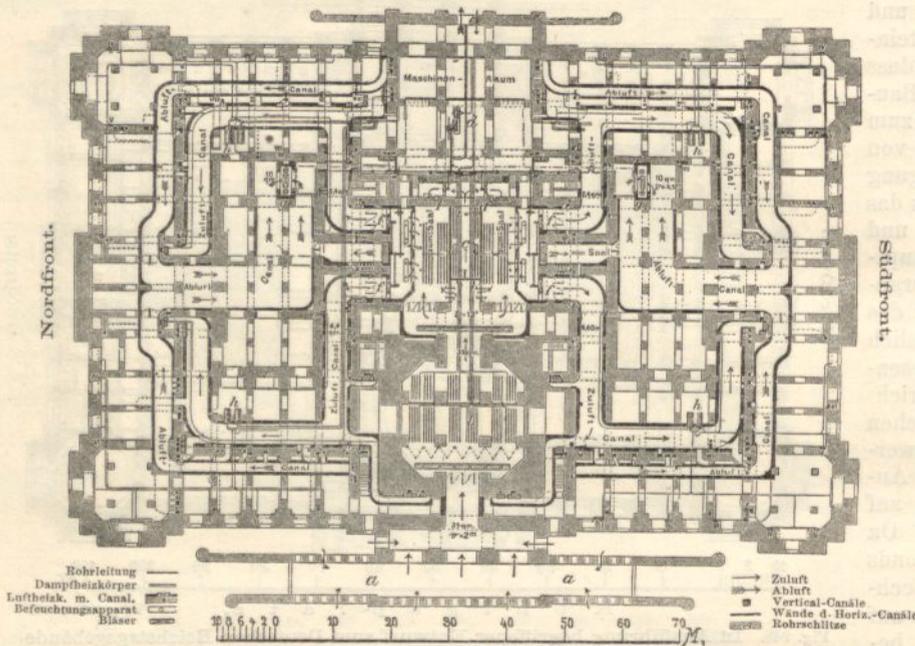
Heizung und Lüftung des Reichstageshauses. Kellergeschoss
